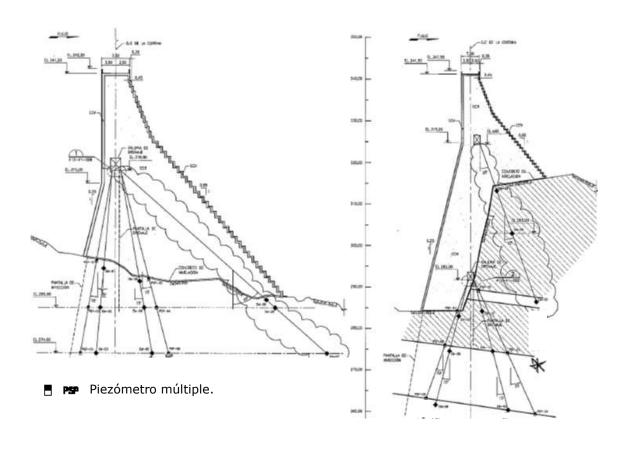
IV.3.3 Vista de la ubicación de los piezómetros múltiples en la zona de galería de la presa, sección B (bloque 2) y sección C (bloque 6).
